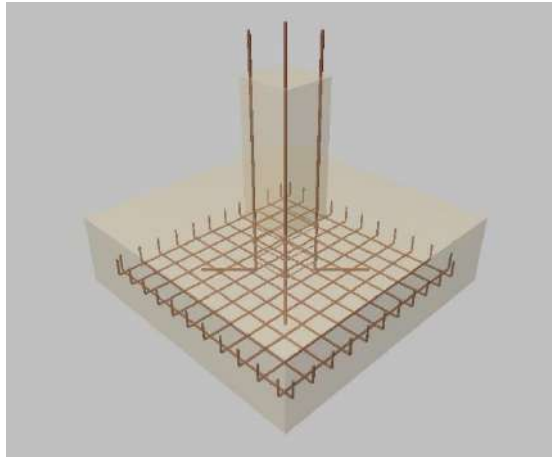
Esquema de Zapatas Fuente: Imagen de Cypecad
